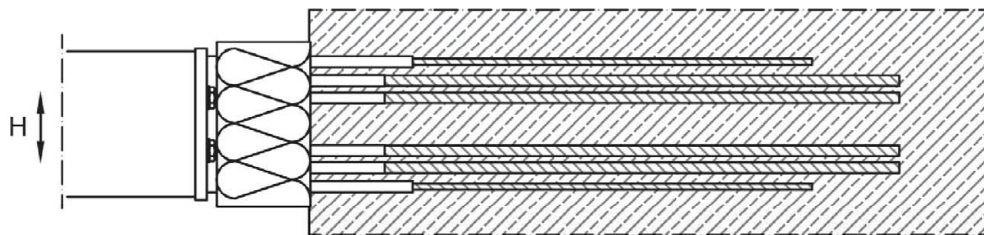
Grundriss IP 120 SM14 QQ
